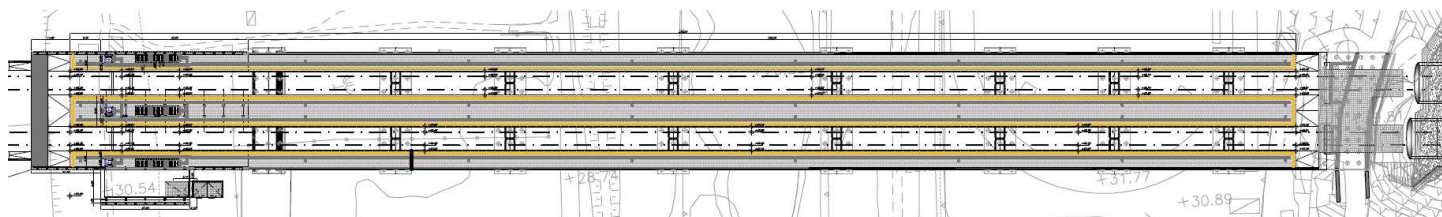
Pianta quota banchina stazione di S. Alessio (Rif.[25])
